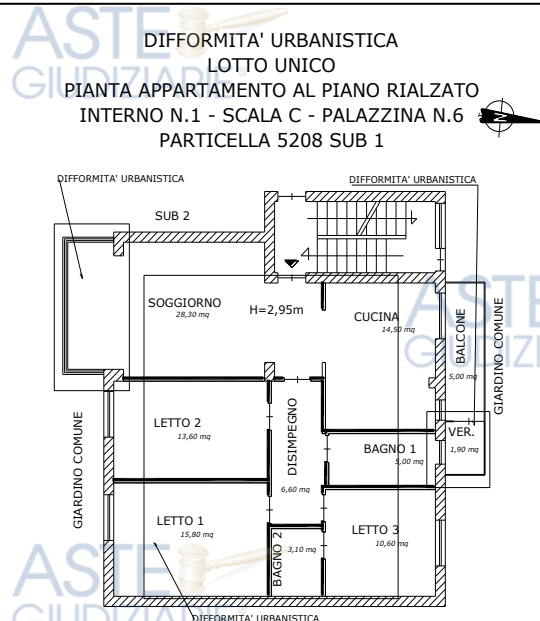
planimetria delle difformità urbanistiche dell'appartamento al piano rialzato
